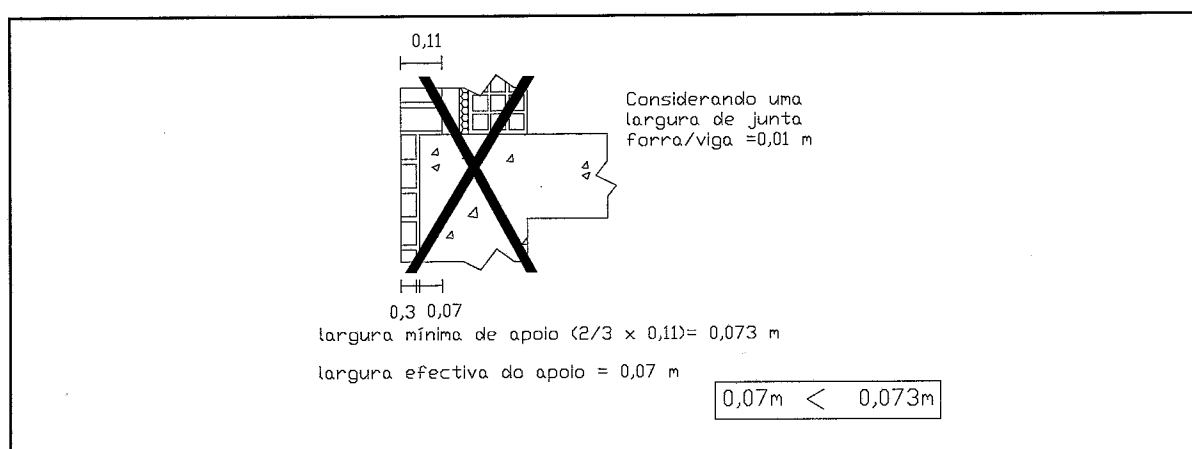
Largura efectiva do apoio e largura mínima de um pano exterior de tijolo de face à vista
